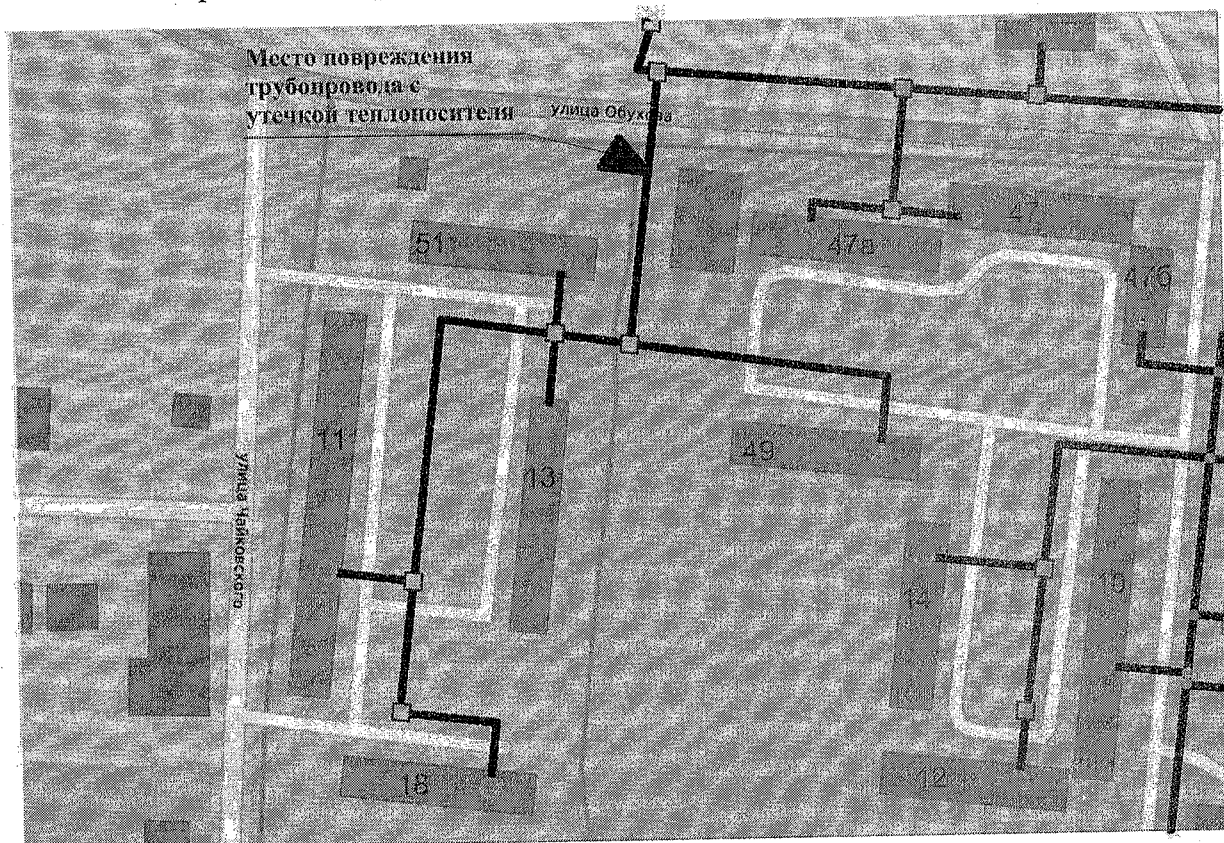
Повреждение участка трубопровода на улице Обухова возле дома 51.
